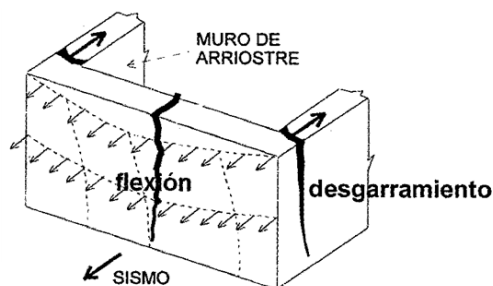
Grietas verticales debidas a fuerzas fuera del plano
